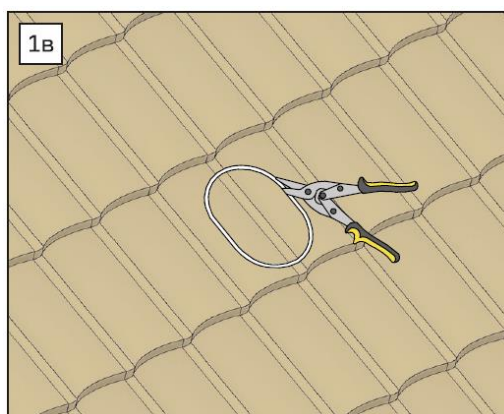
в – Разметка контура и выпиливание отверстия для проходного элемента Döcke MONTERREY.
